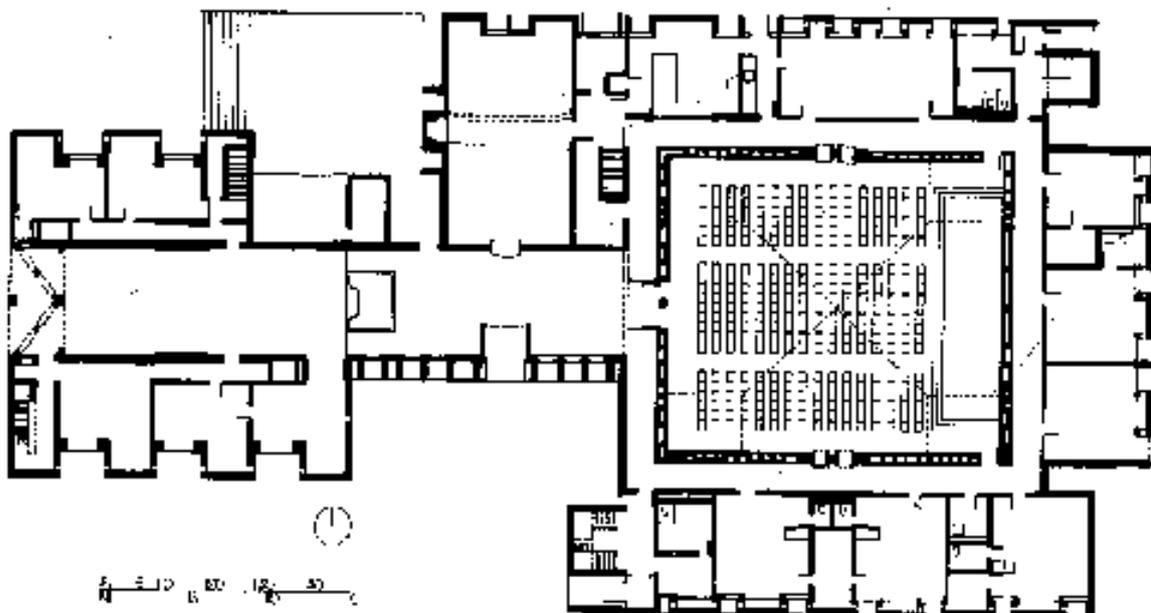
Planta baixa da igreja unitariana de Rochester.
